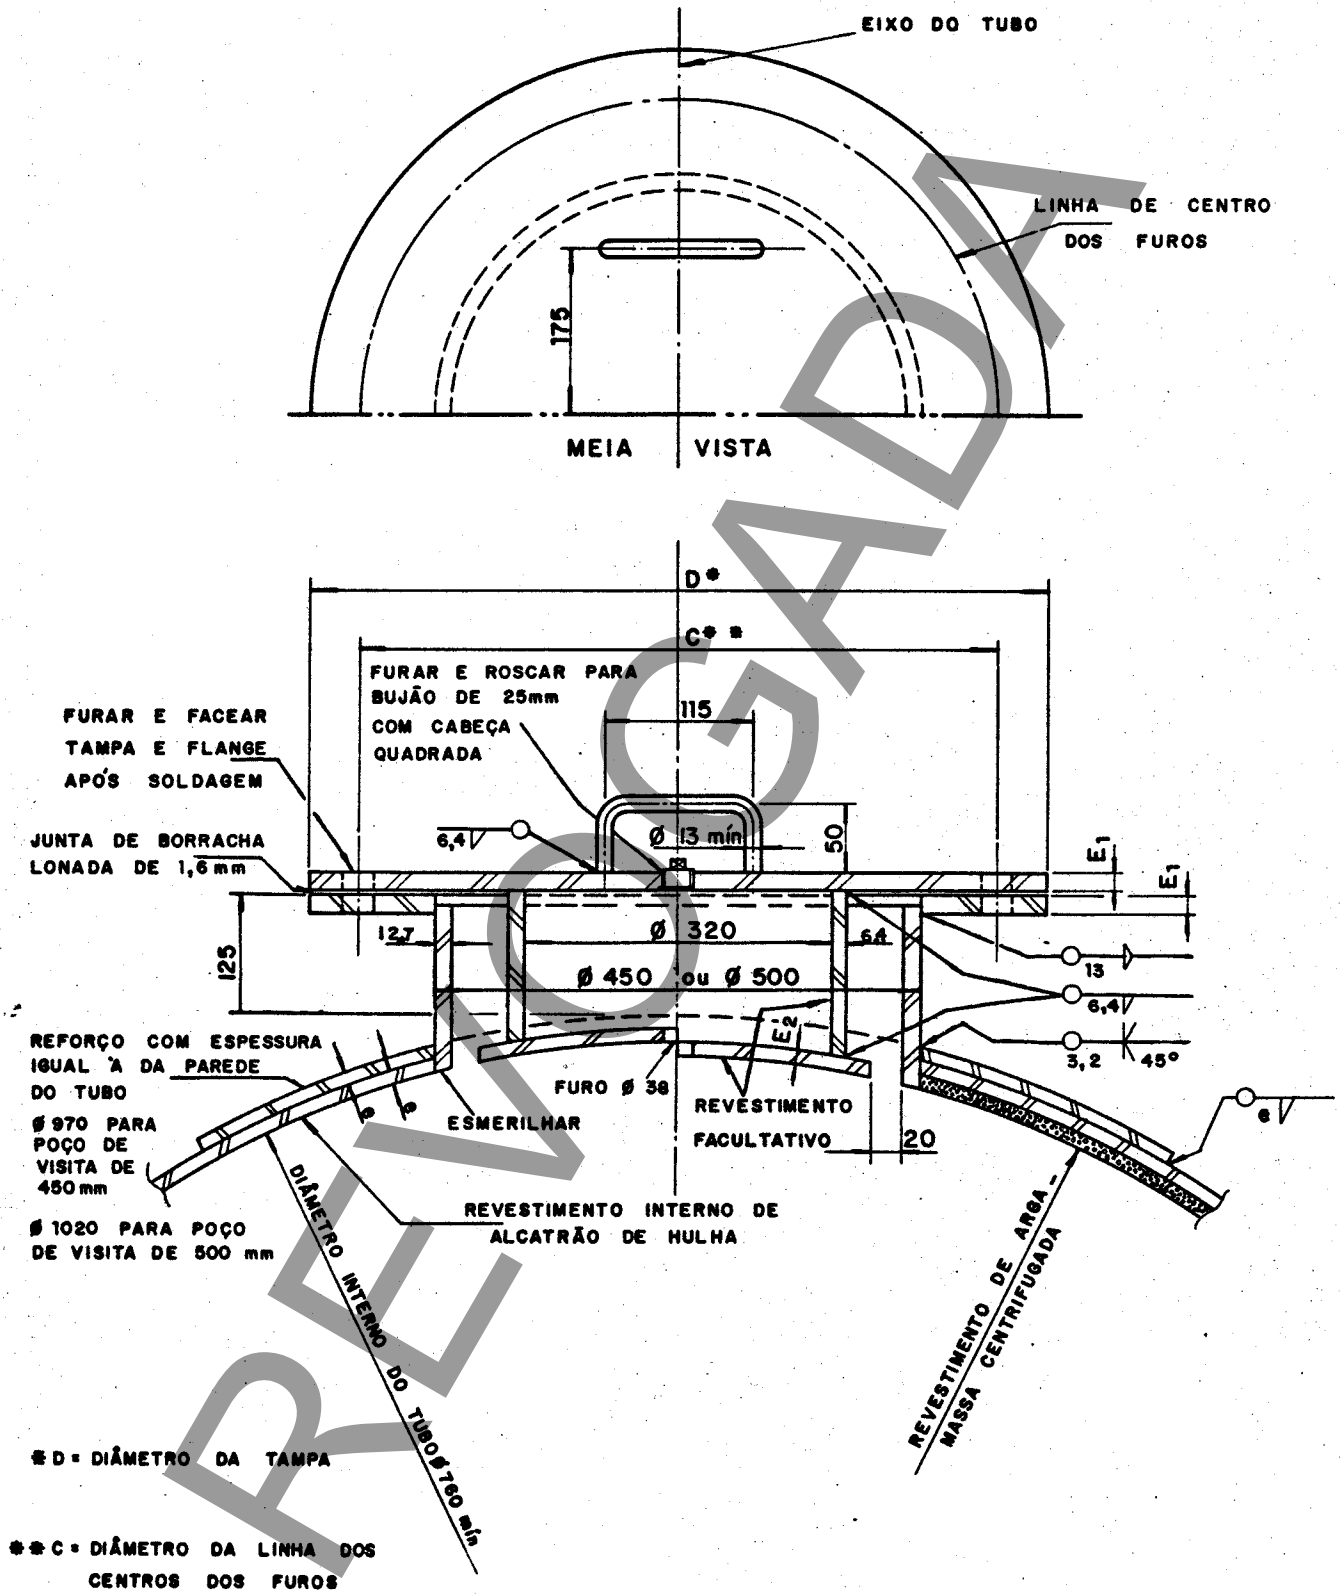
POÇOS DE VISITA DE AÇO SOLDADO
